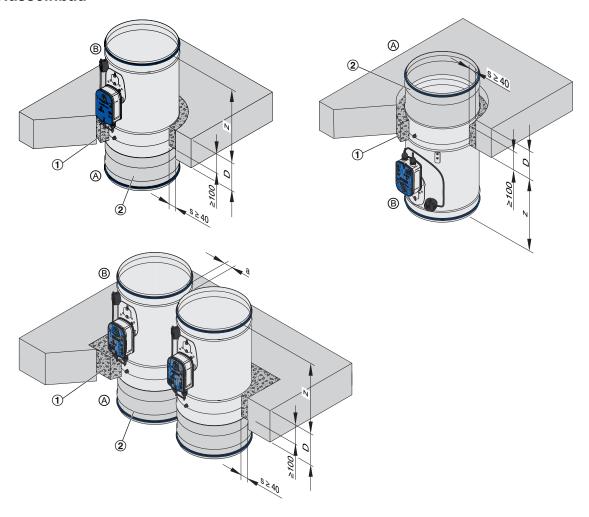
Einbau in Massivdecke, stehend, hängend und "Flansch an Flansch"
